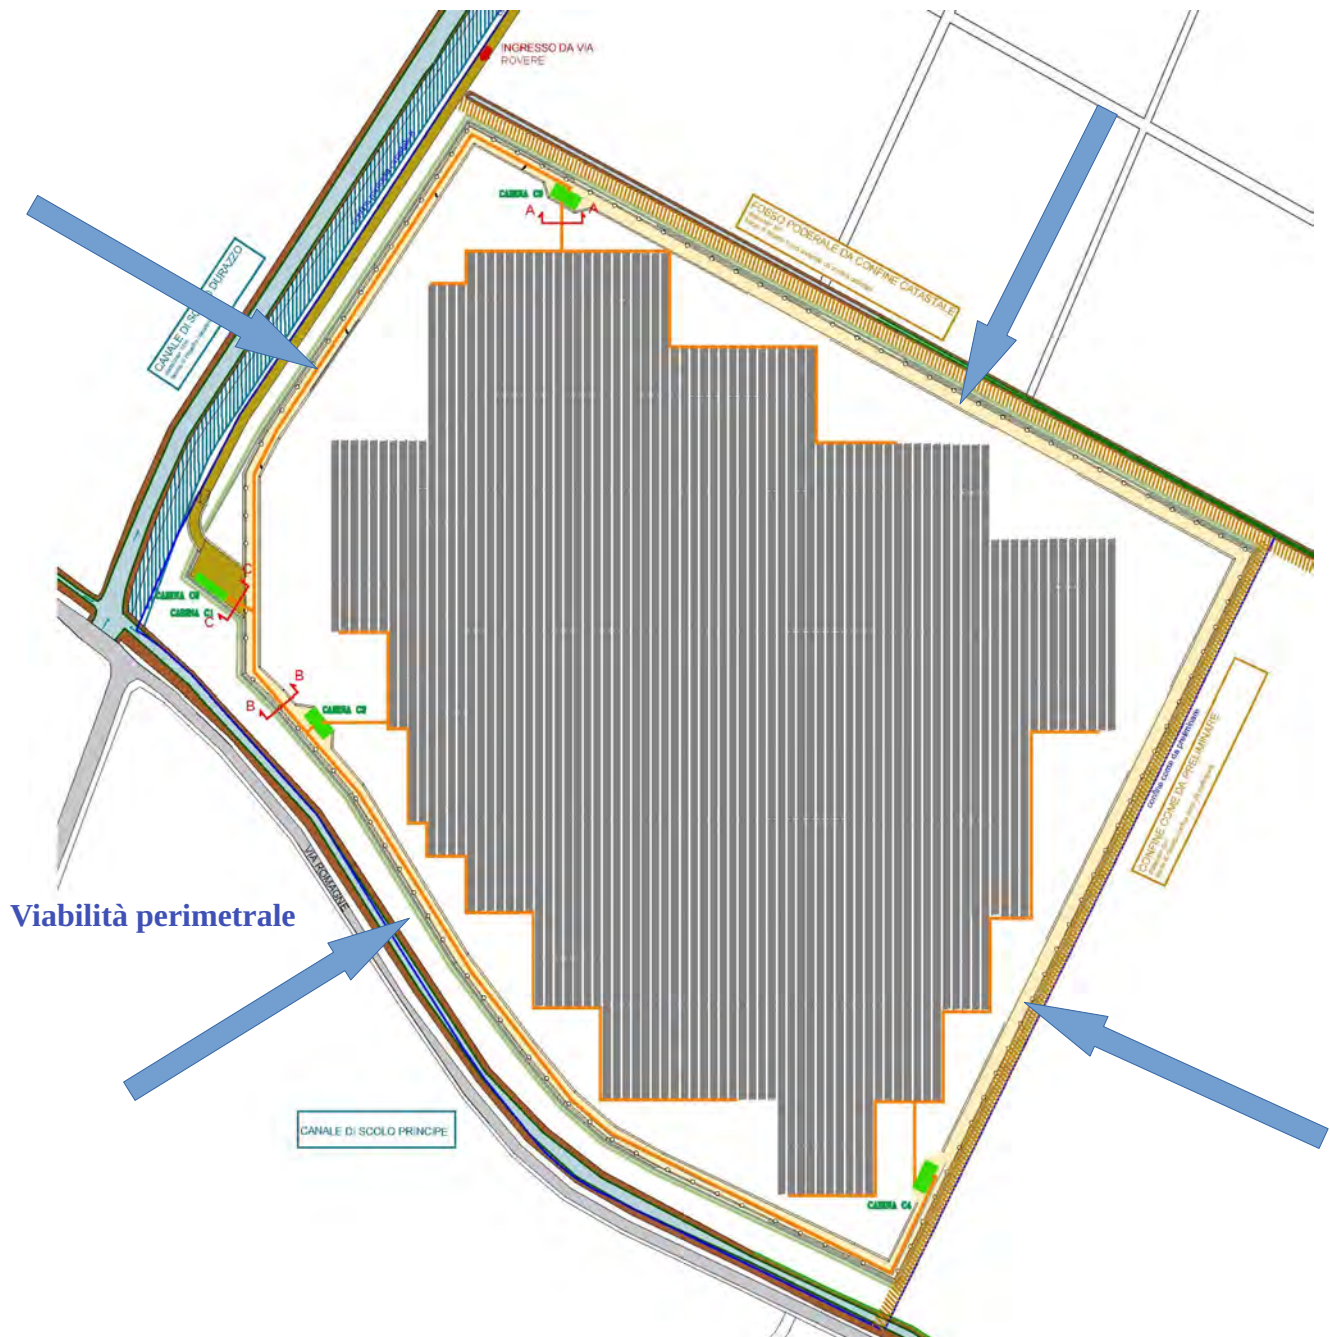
Area di impianto - individuazione area di riutilizzo delle terre e rocce da scavo
